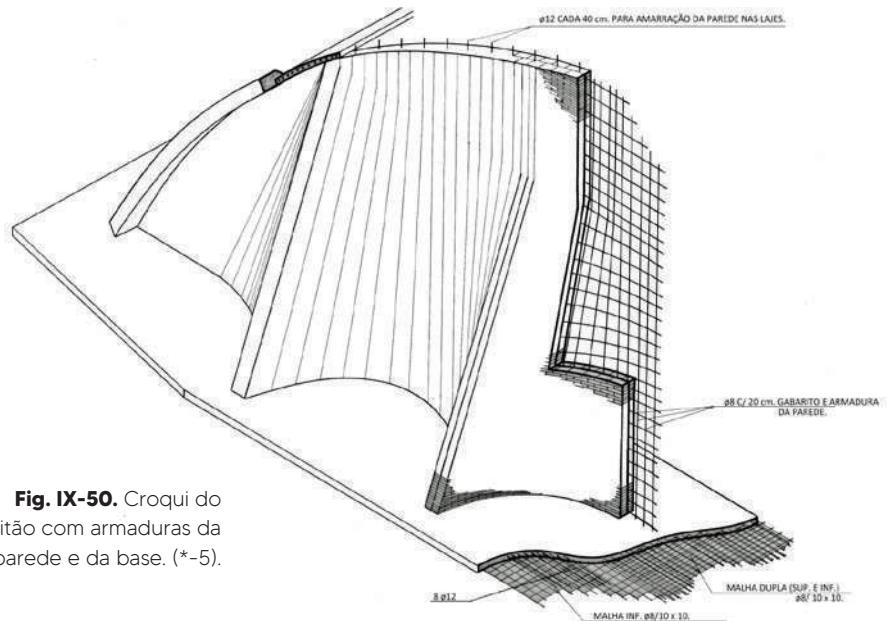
Croqui do oitão com armaduras da parede e da base. (*-5).
